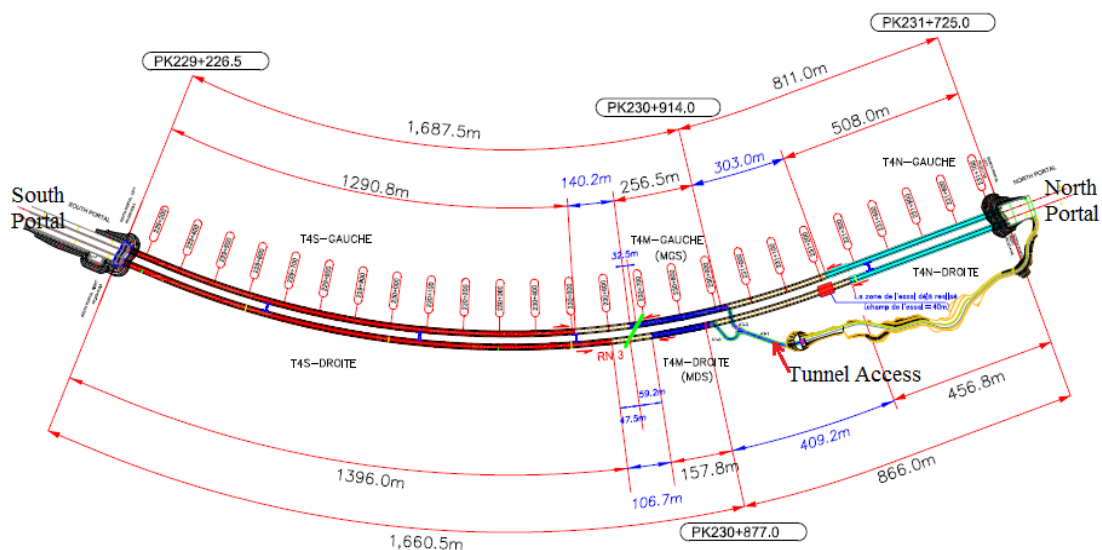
Vue en plan et section longitudinale du tunnel T4
